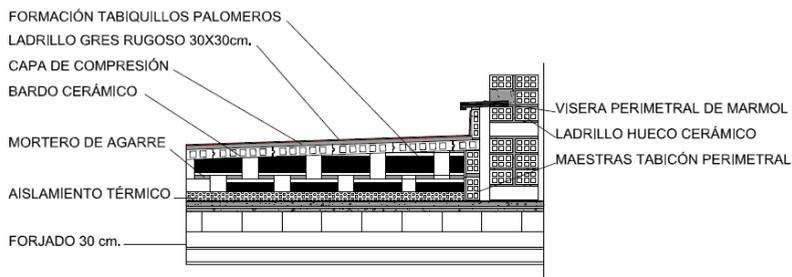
Sección vertical de la fachada Este de la vivienda rehabilitada.
